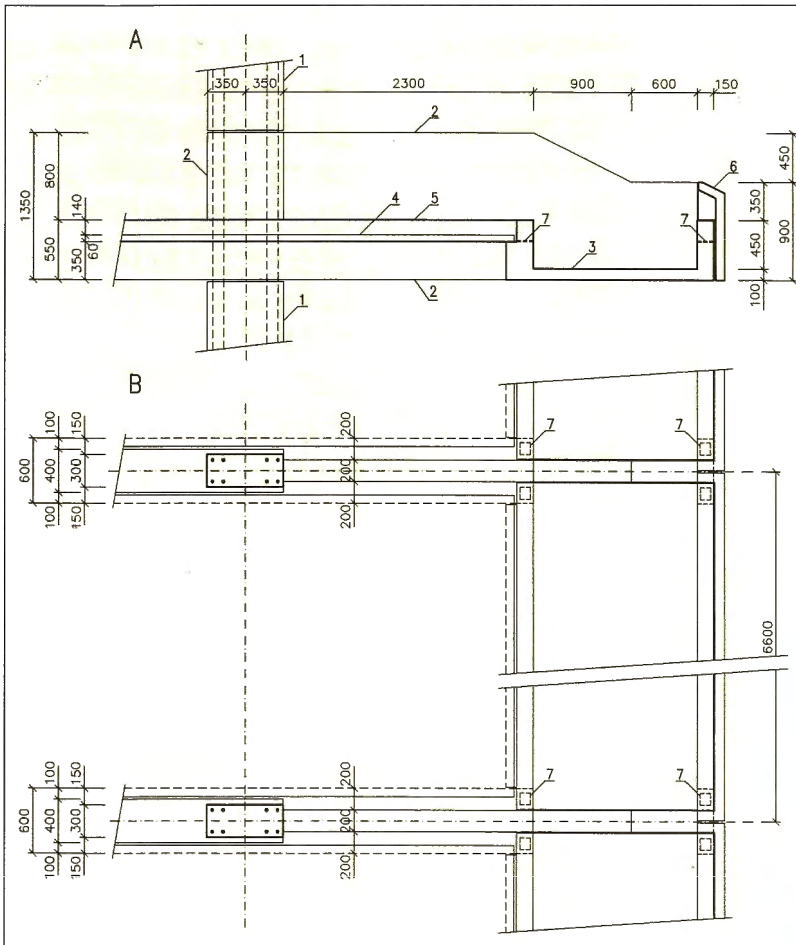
Příčný řez konstrukcí s ocelovým přístřeškem a pilotovými základy / The vertical cross-section of the skeleton with steel shelter and bored piles
